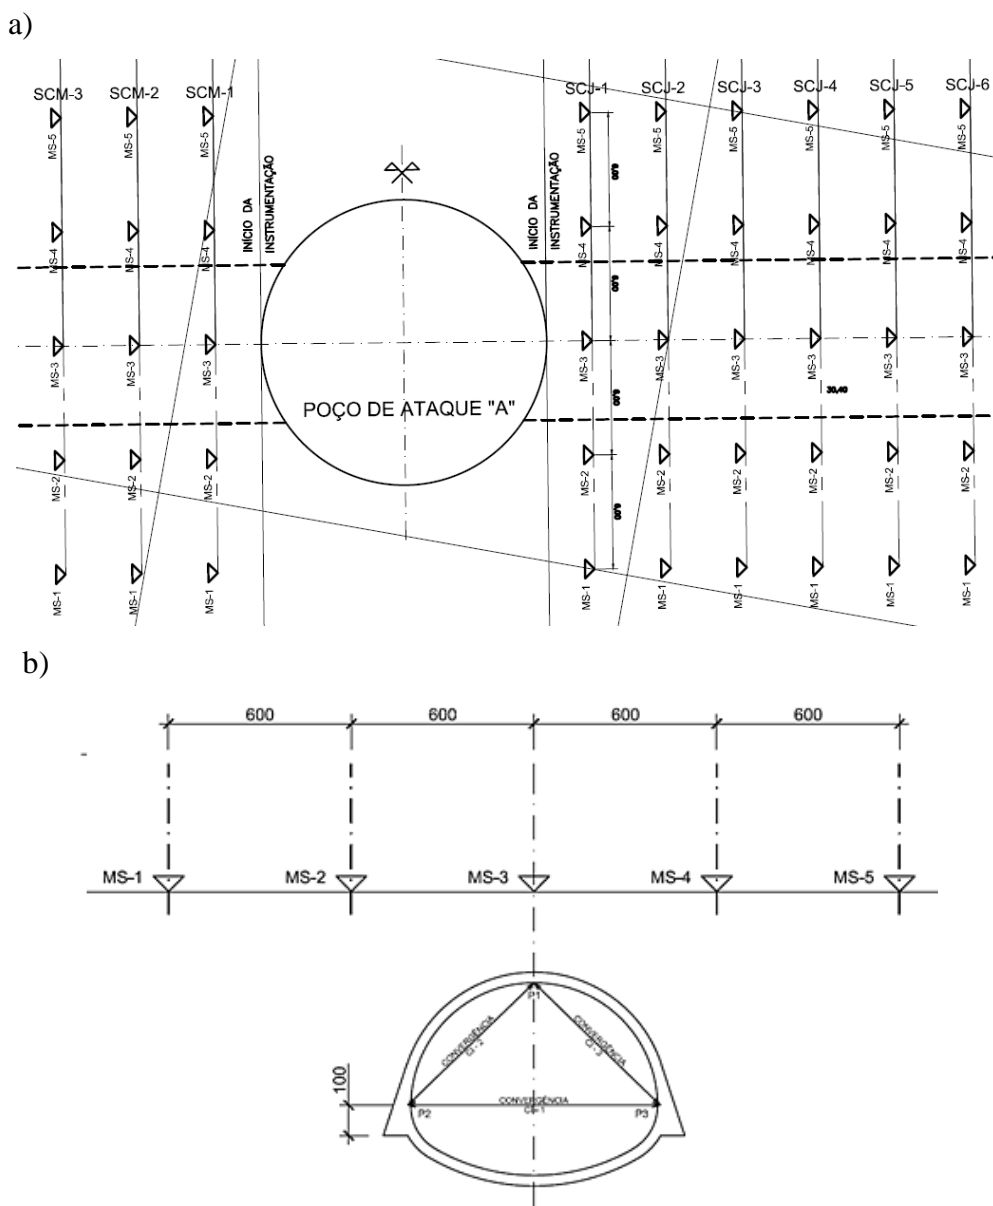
Detalhe da instrumentação do túnel. a) Planta b) seção transversal (Acervo Terratek 2013)
